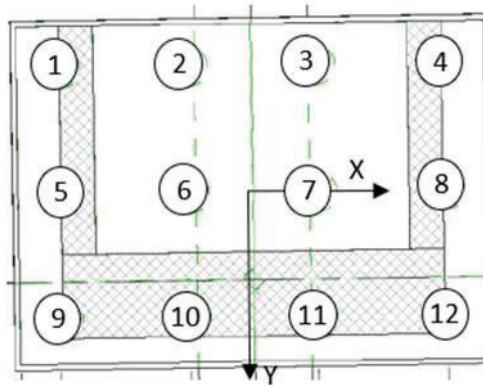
Sistema di riferimento per le fondazioni delle spalle con indicazione della numerazione dei pali
